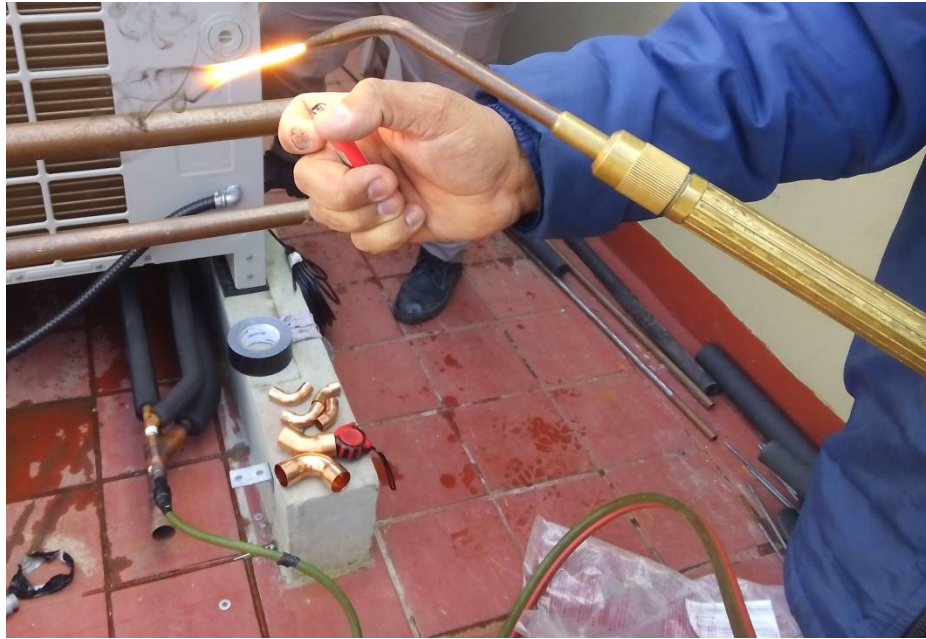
Acendimento do maçarico realizado pelo soldador “B”
